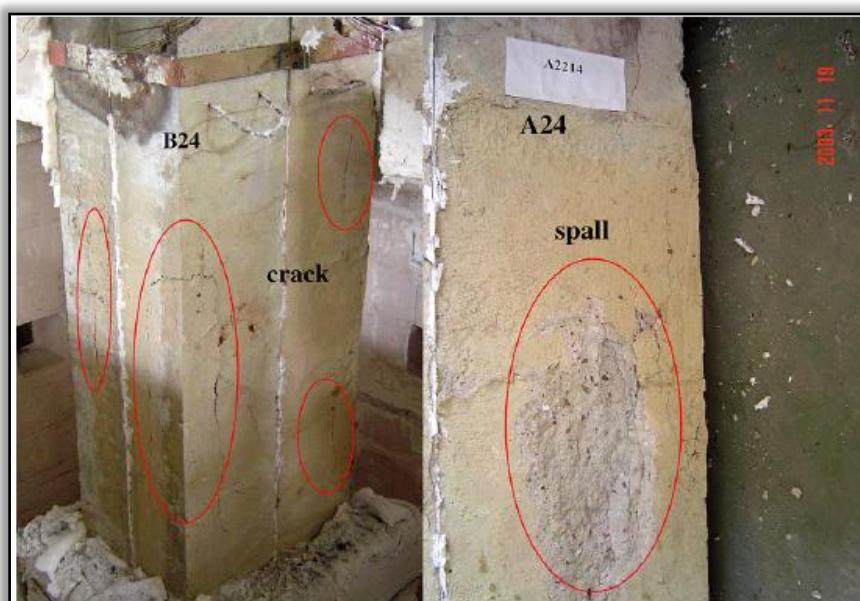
Fissuras e *Spalling* nas amostras de betão (Jau et al., 2008) .
